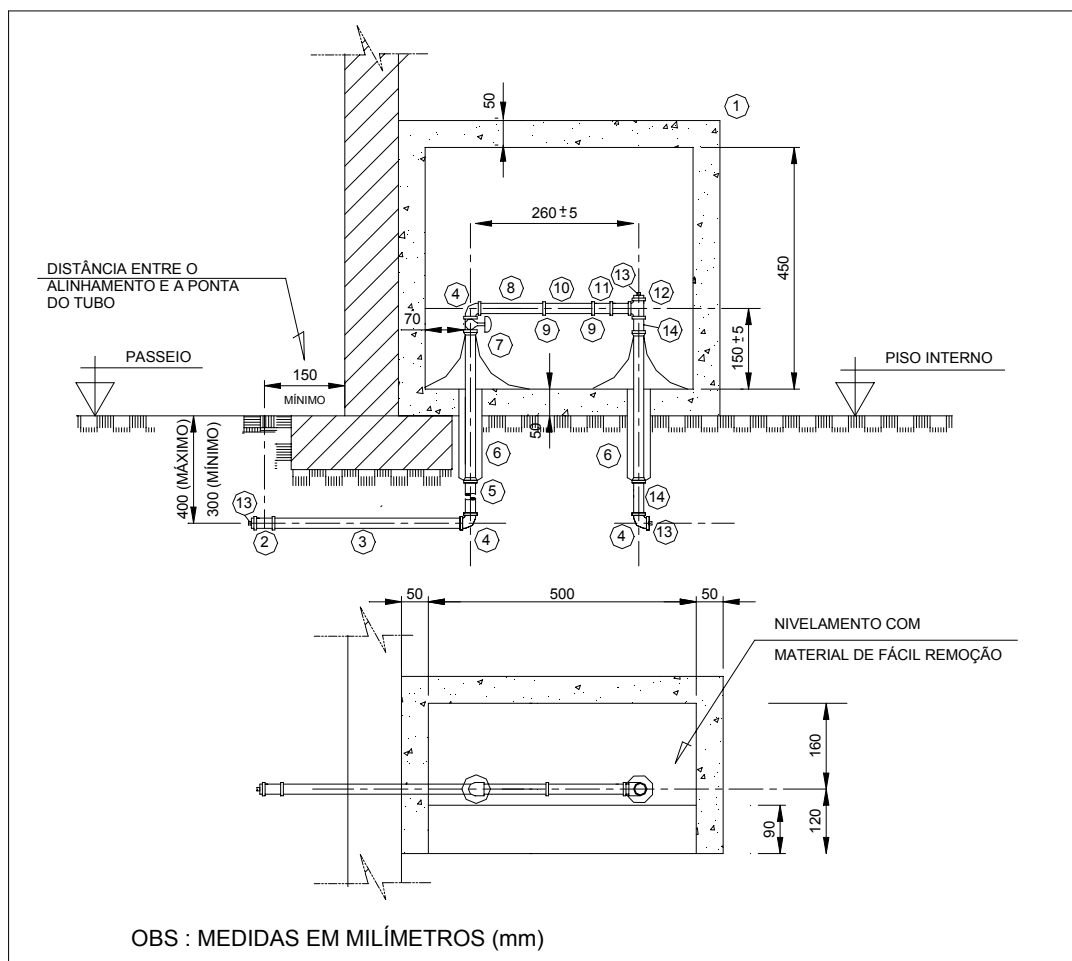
Instalação com abrigo e cavalete de PVC rígido
